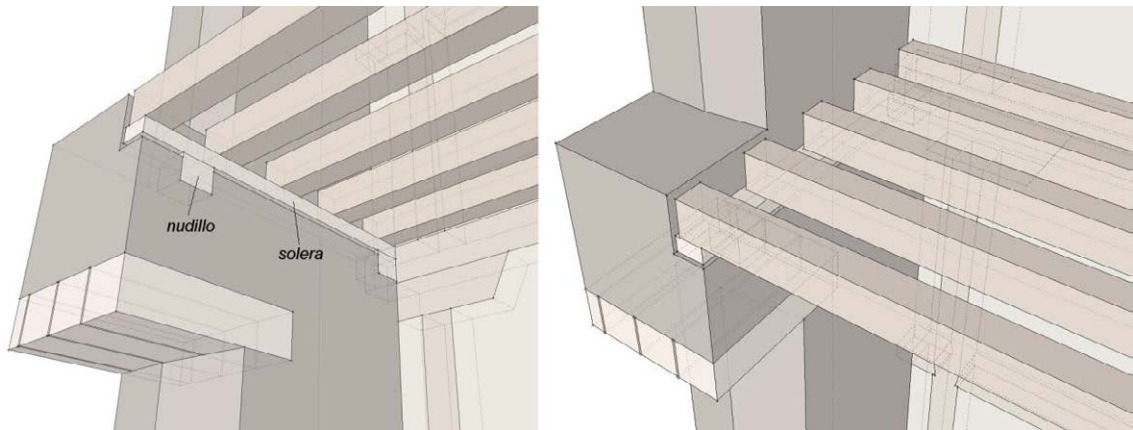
Apoyo del forjado en el muro de fachada a calle con nudillo y solera
